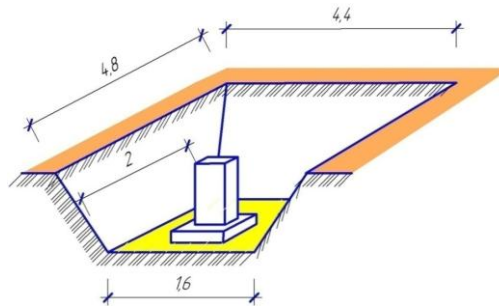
Котлован-яма под отдельно стоящий фундамент
